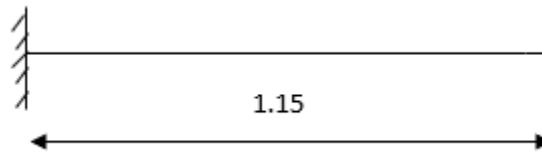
schéma statique de la Poutre palière de sous-sol.
